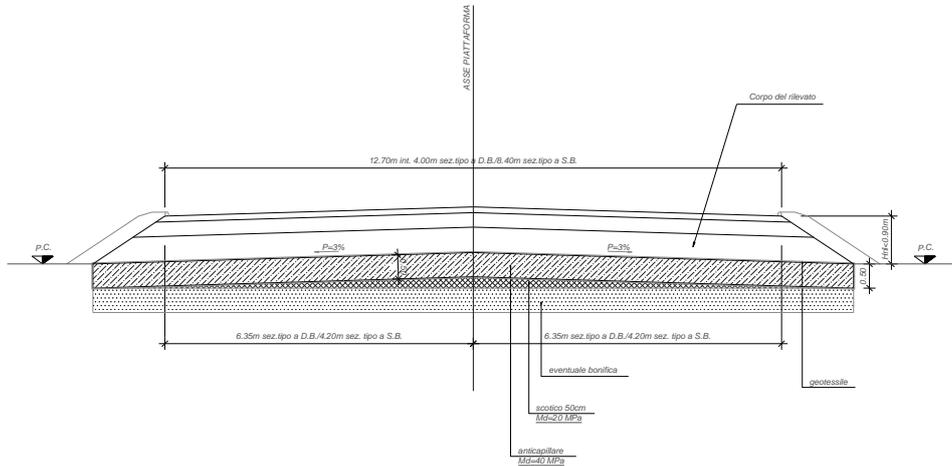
Strato di fondazione per rilevati  $H_{rel} < 0,90 m$
